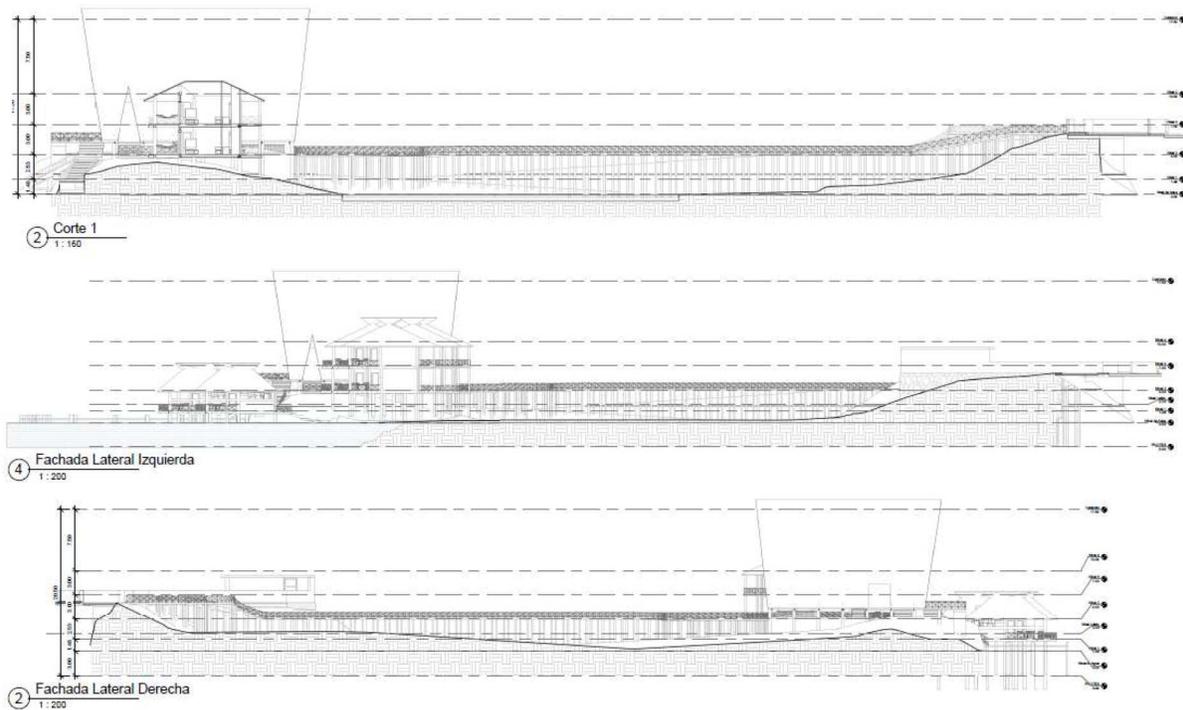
Esquema general de conjunto para el sendero o andador de acceso y plataforma constructiva elevada para la infraestructura del centro ecoturístico.
